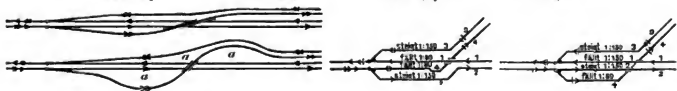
bis 406. Schienenfreie Abzweigung der Führerleise von den durchgehenden Hauptgleisen.
